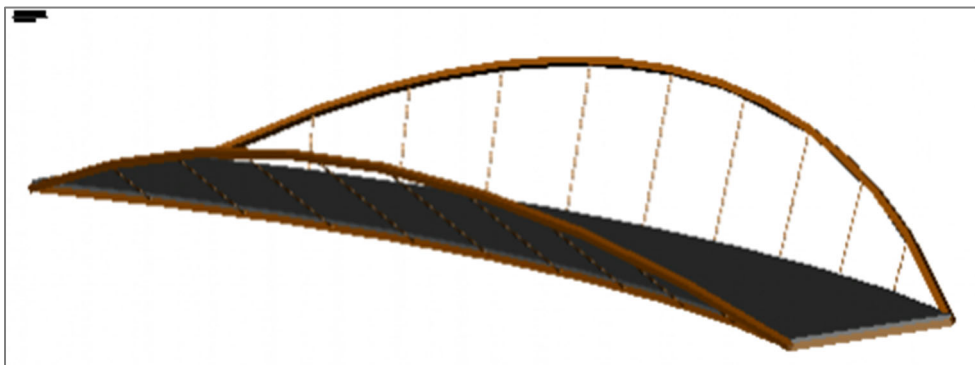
Vista 3D struttura ponte sul rio San Girolamo
